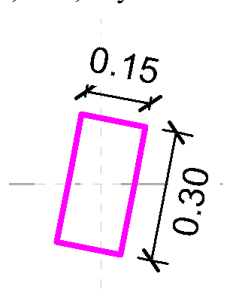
Extrusión de la geometría de la Viga_Rampa_Prefabricada_0,30x0,15. Fuente: Elaboración Propia.
